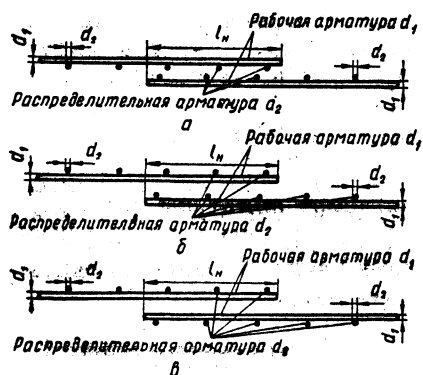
Устройство стыков сварных сеток в рабочем направлении внахлестку (без сварки). Расположение стержней:
